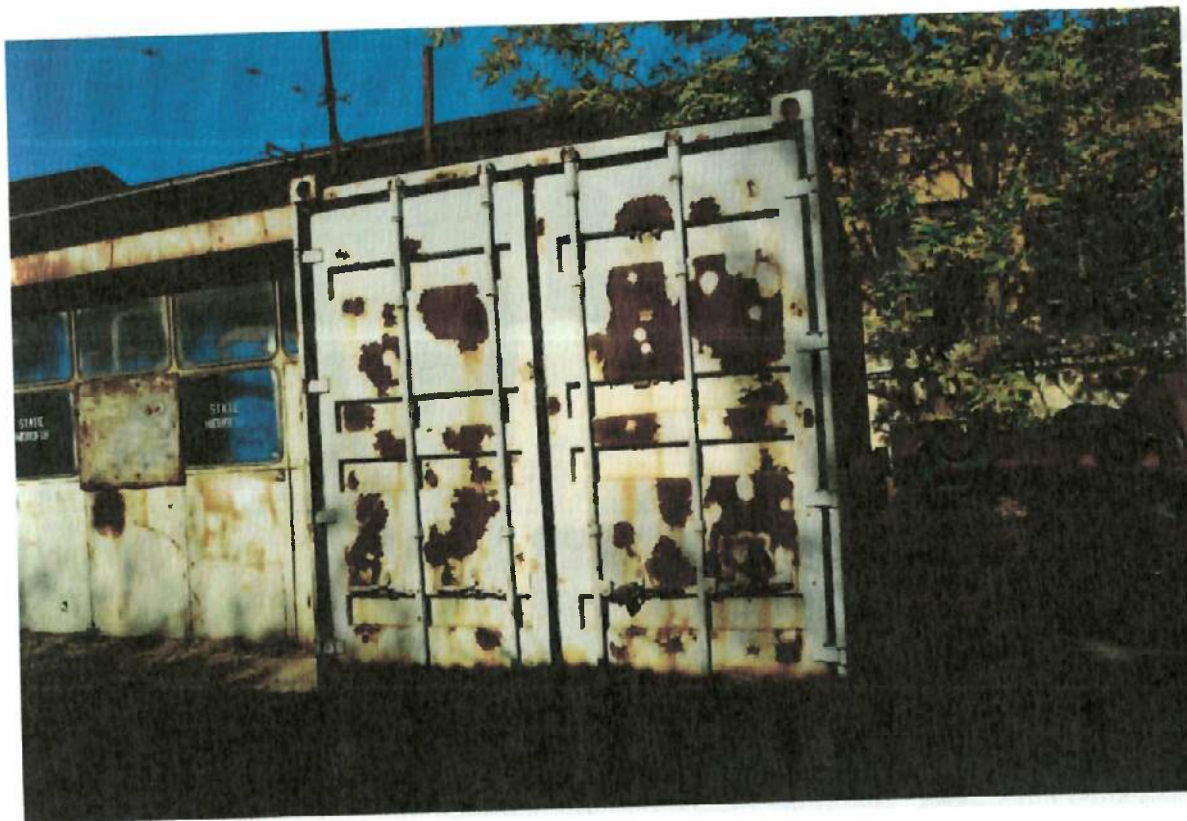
Magazie Metalică (C30): Structură metalică prefabricată
